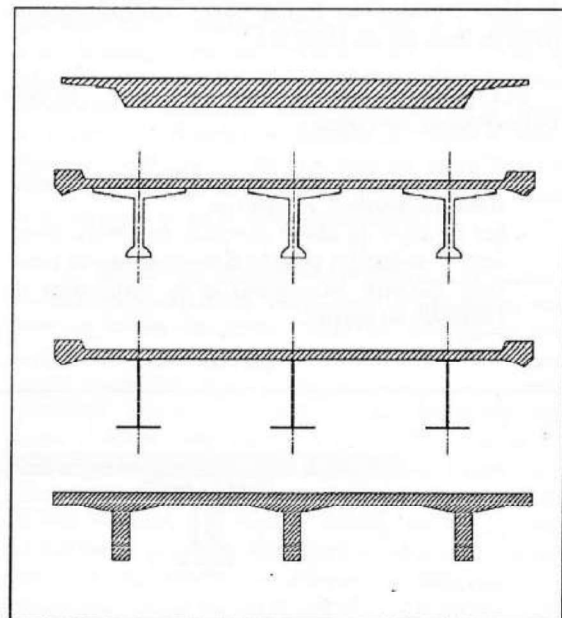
Exemple de ponts pouvant être calculés en dalle + poutres.
